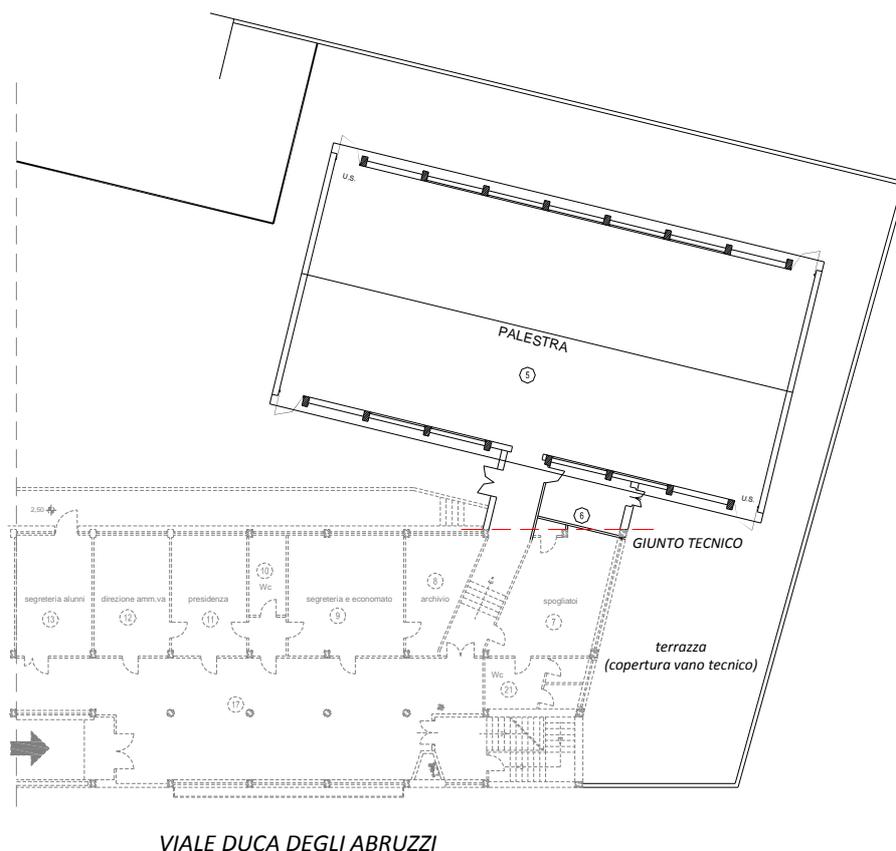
Pianta generale palestra con indicazione del giunto tecnico di separazione dal blocco aule.
